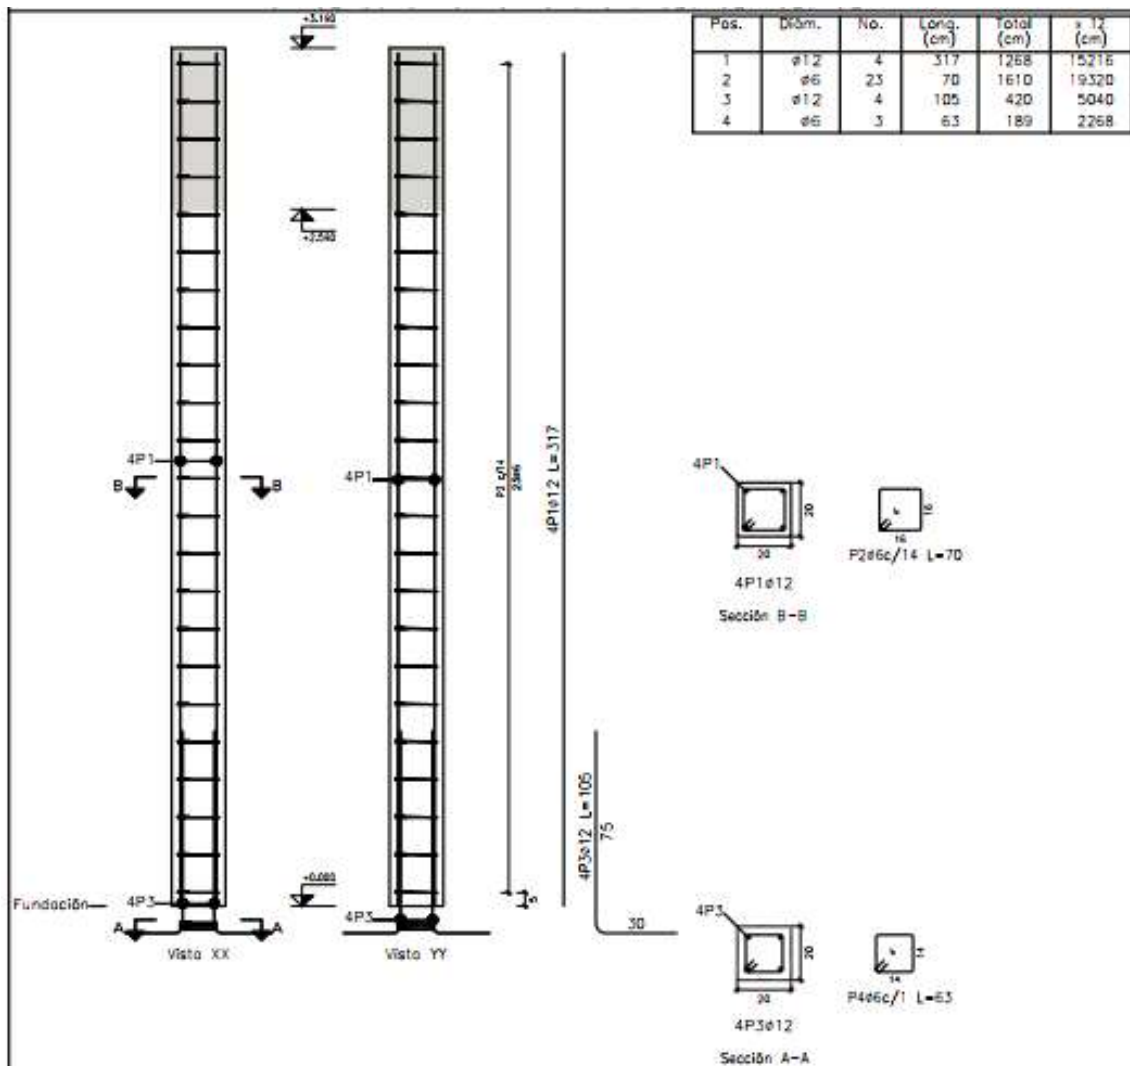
Armado de columna más solicitada (fuente: elaboración propia).
